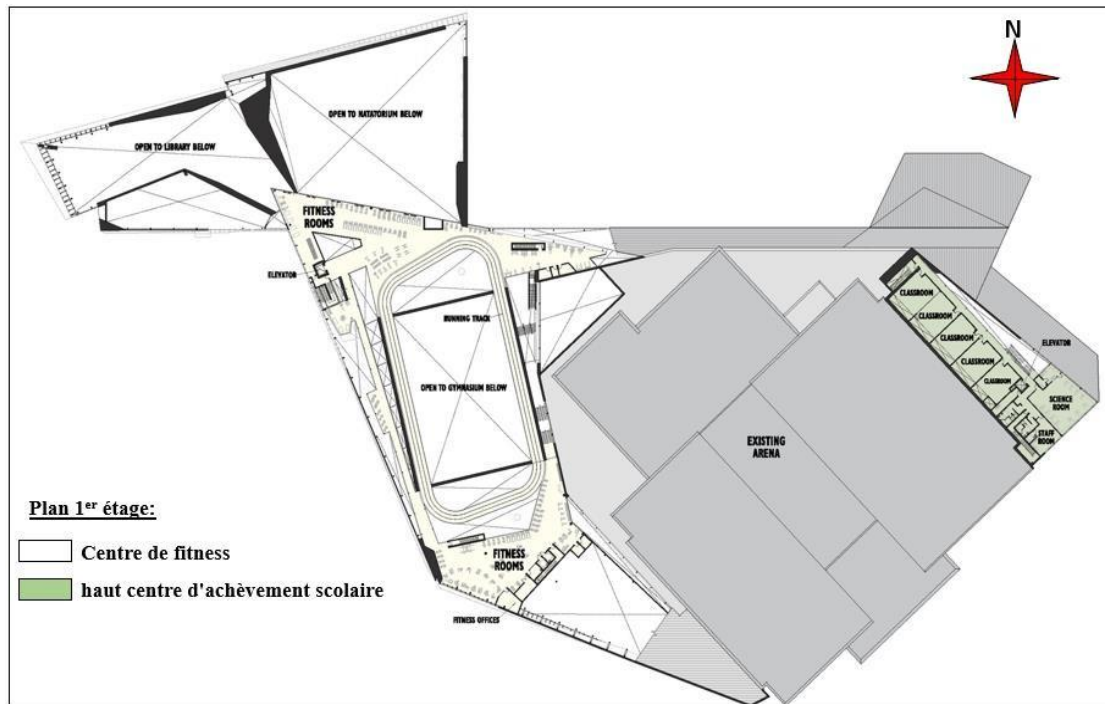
Plan de 1^{er} étage du centre de loisirs de Clareview. (Source : Archdaily.com)
